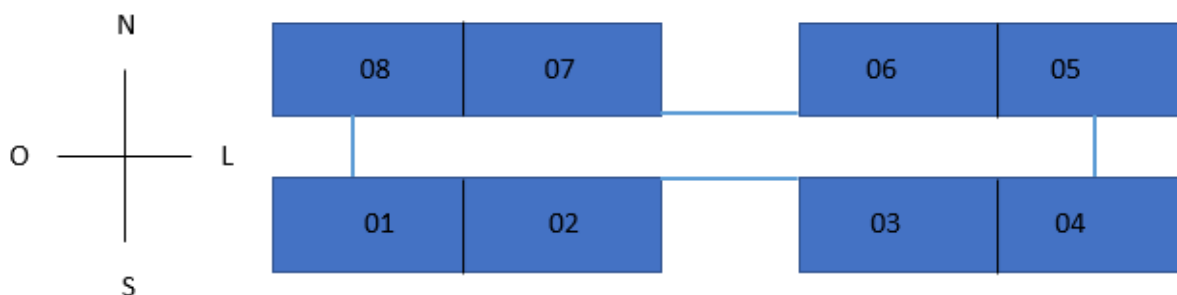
Planta baixa do apartamento utilizado como objeto do estudo.
